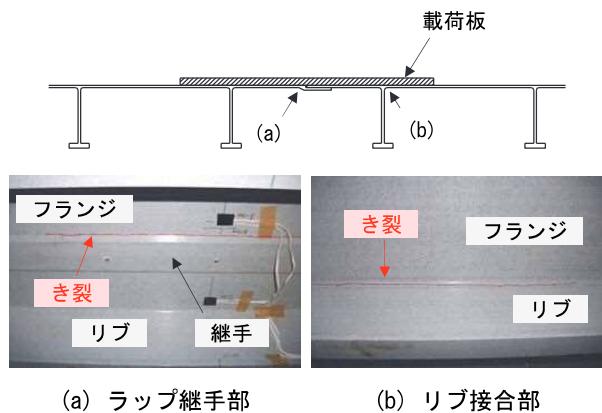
鉛直力載荷（分布）試験の供試体損傷状況
